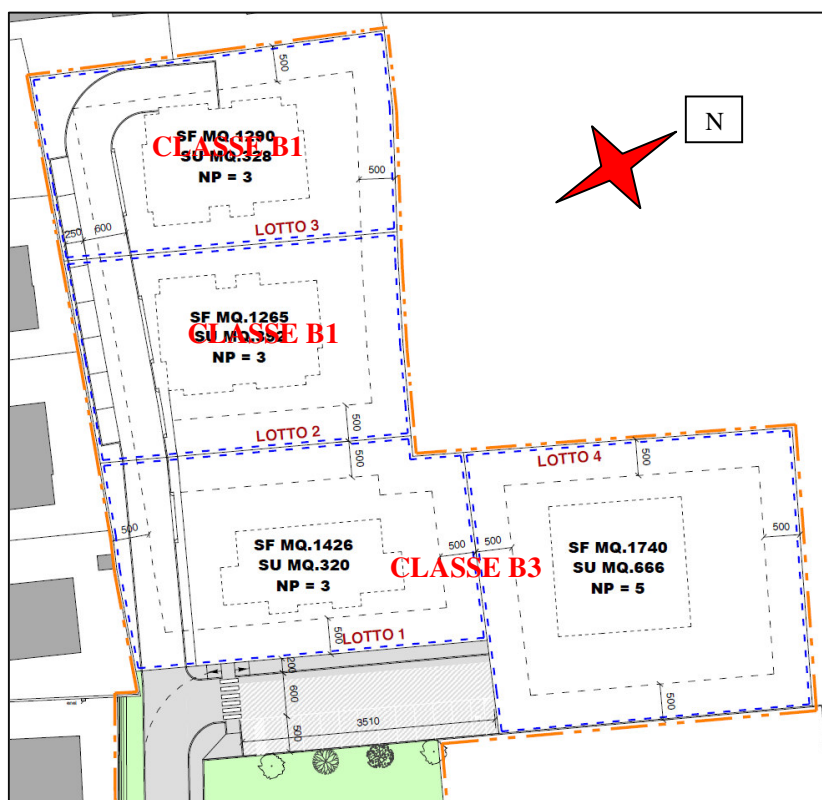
Zonizzazione geomeccanica dell'area. Estratto da Planimetria di progetto in scala 1:1.000
